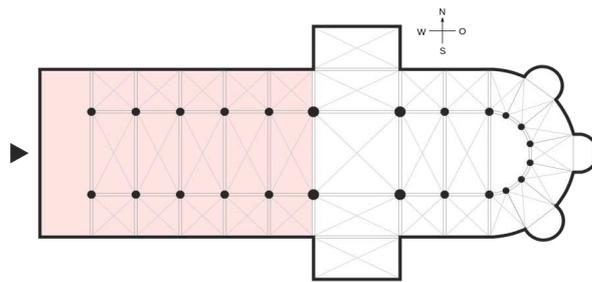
Plan chapelle Saint-Luc (Nef en rouge)
